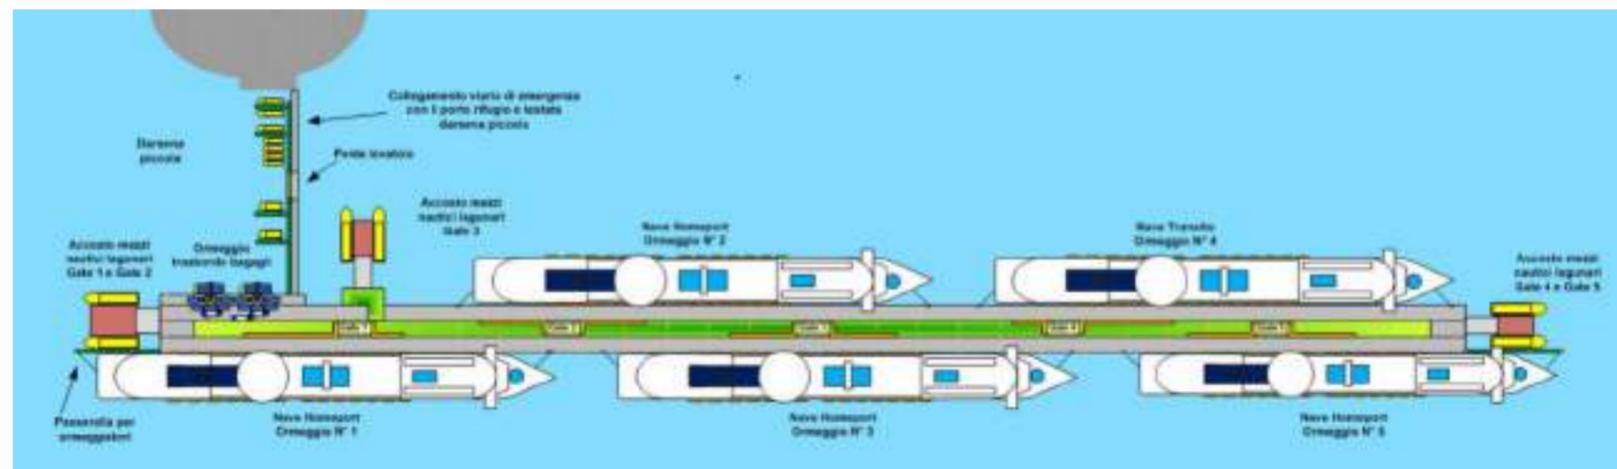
Venis Cruise 2.0, Planimetria di Progetto
